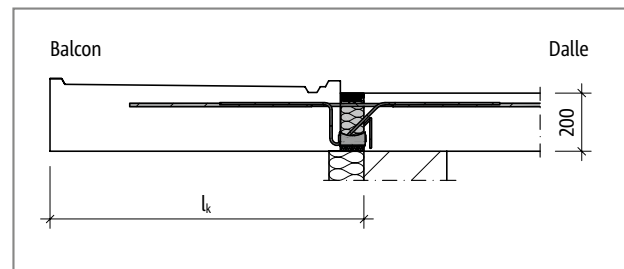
Schöck Isokorb® T Type K-E, K-T : Système statique, coupe
